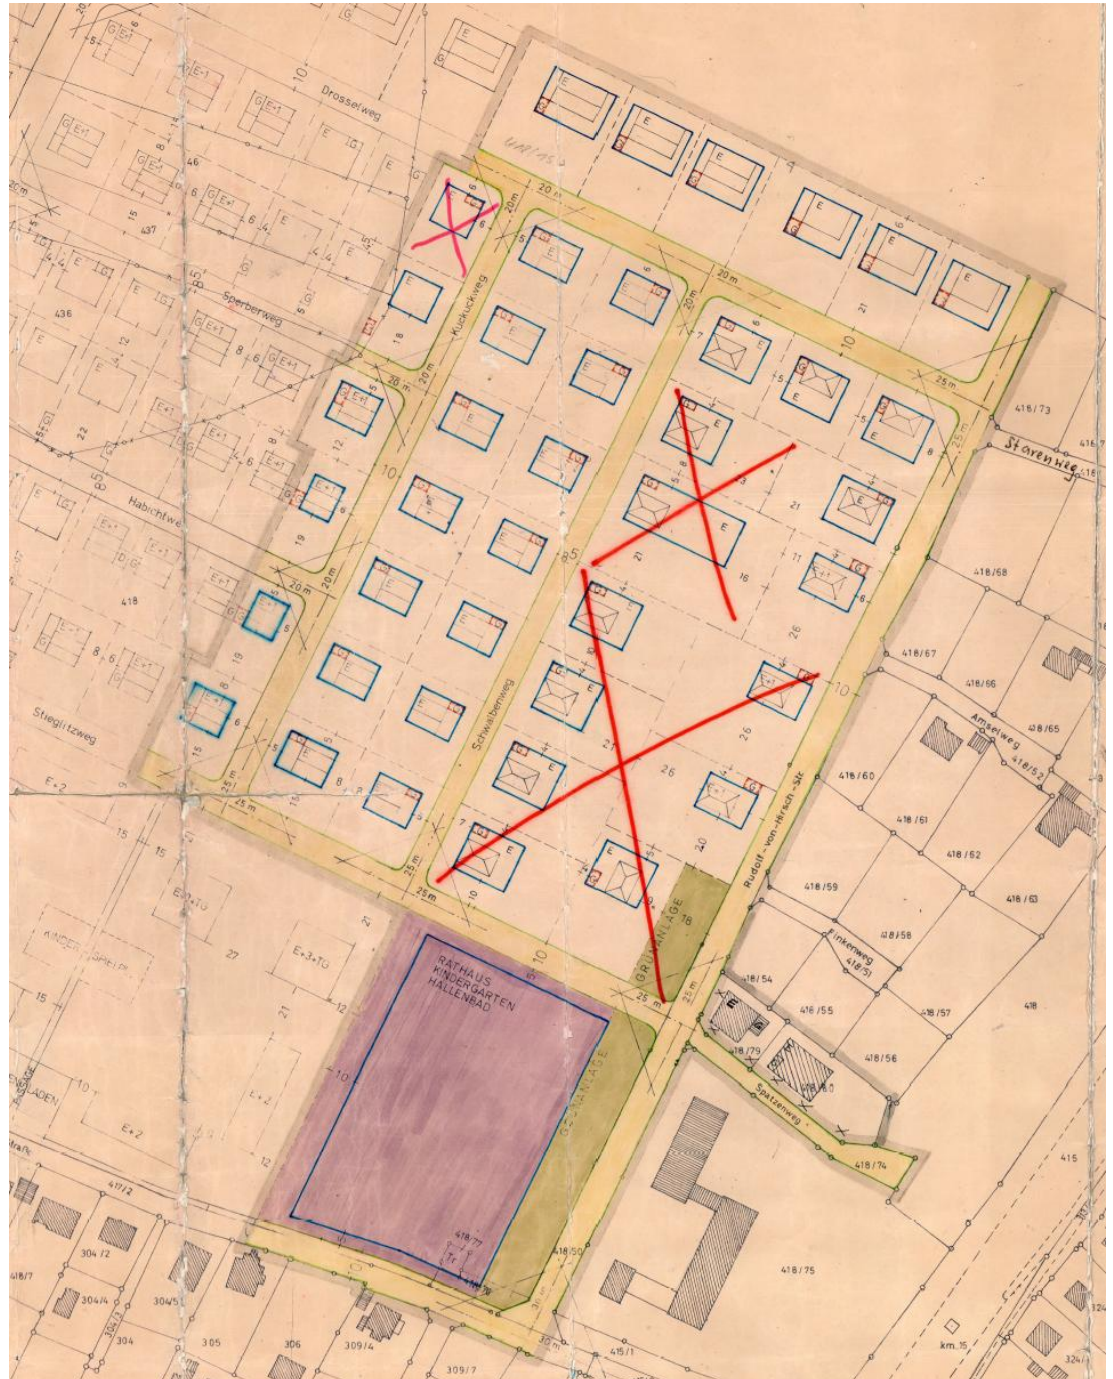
Planzeichnung des BP 23 (14.01.1966)
